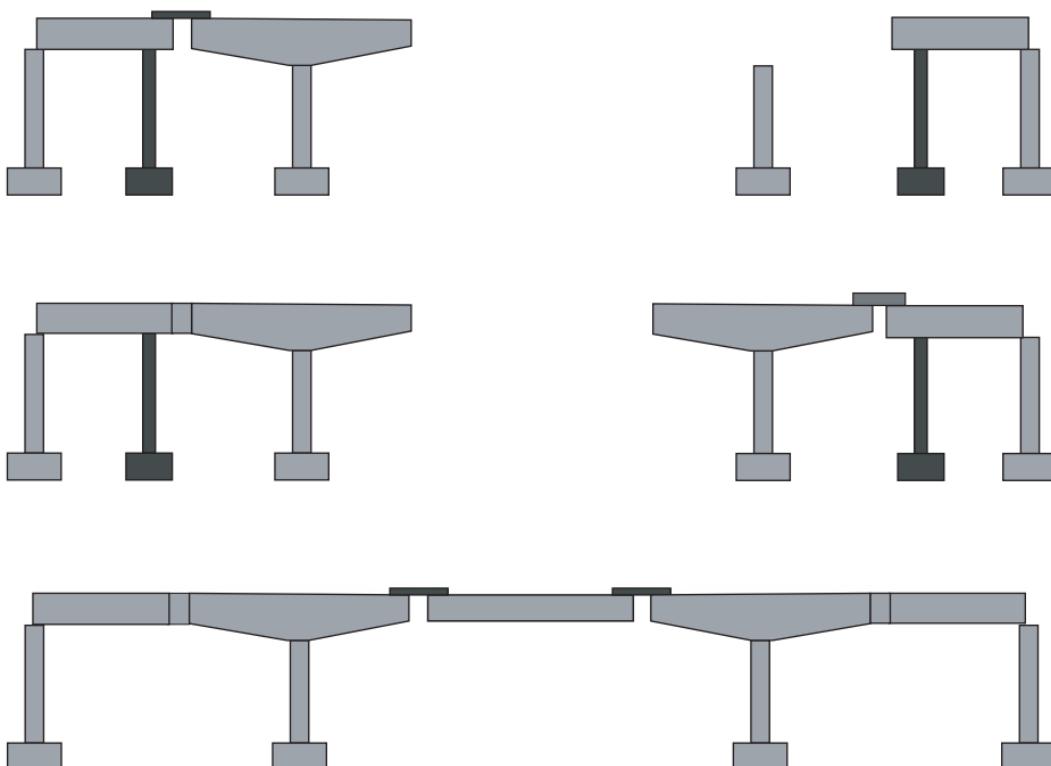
Secuencia de erección y soportes temporales para la viga principal-I empalmada.
